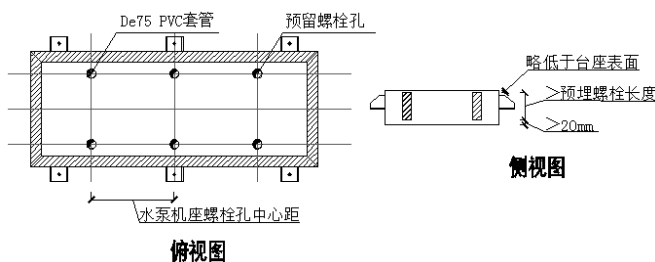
钢筋混凝土隔振台座预留螺栓孔洞图
